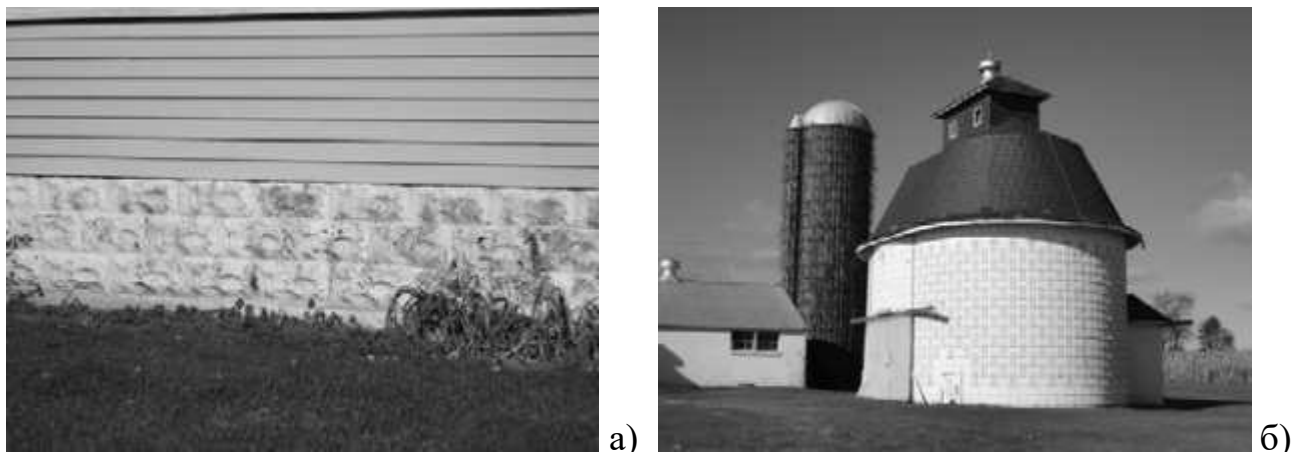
а) Деталь фундаменту будинку у стилі бунгало з бетонних блоків з текстурою скельної поверхні на фермі Ніс-Карвер; б) бетонний блоковий амбар, а також бетонний ставовий силос [81, с. 40].
